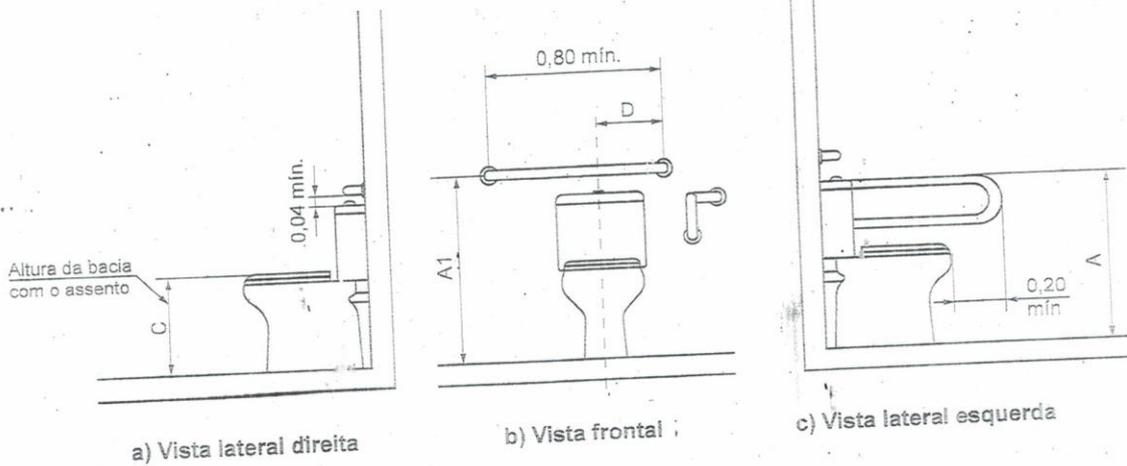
Sem parede lateral – Bacia convencional ou suspensa com barras de apoio reta e lateral fixa – Exemplo A
